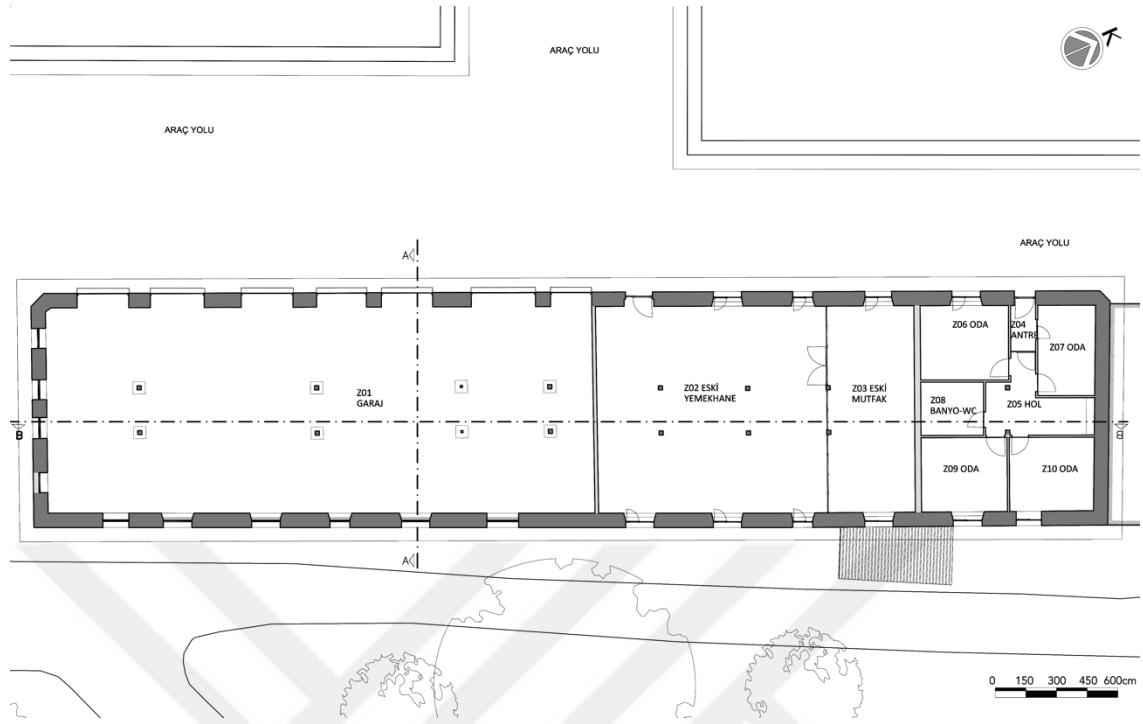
Garaj Binası Vaziyet Planı, 2018
